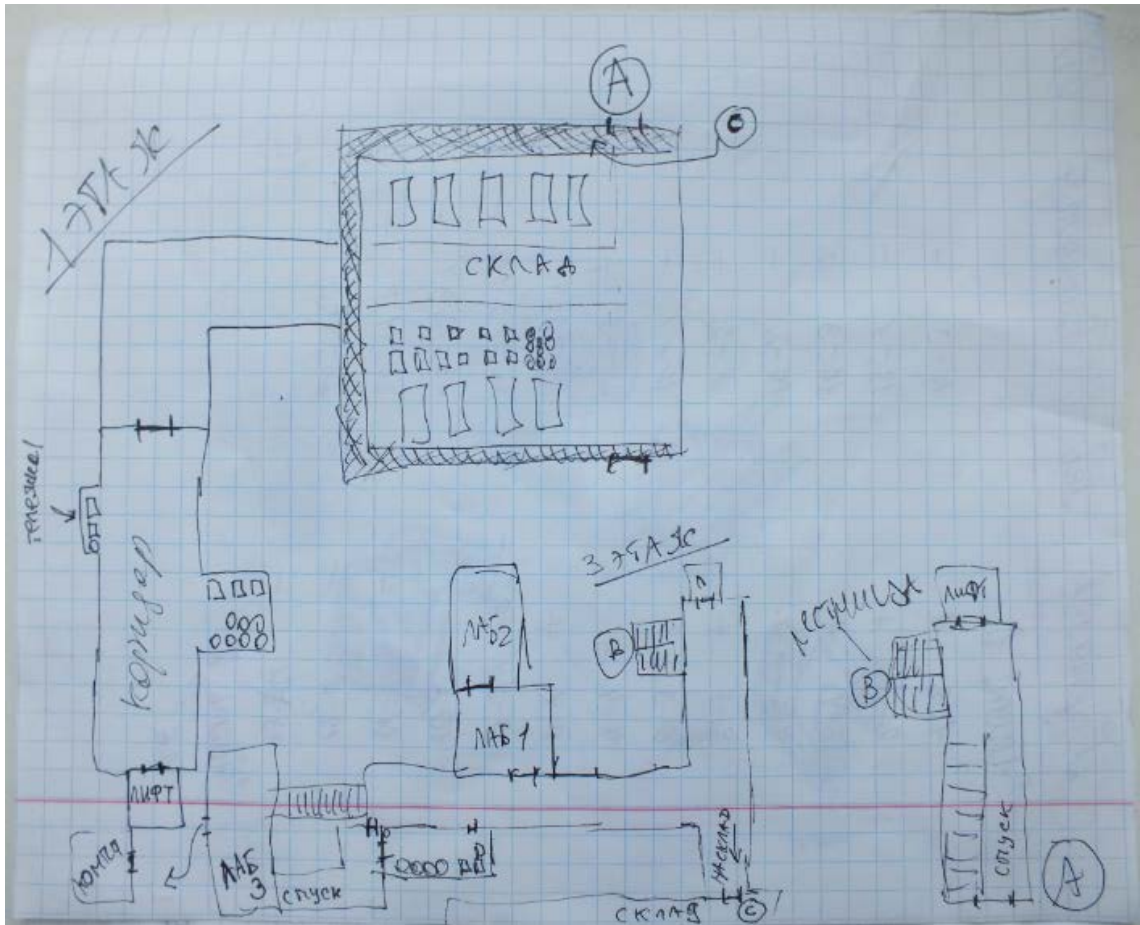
Эскиз всего лабораторного комплекса, вид сверху
